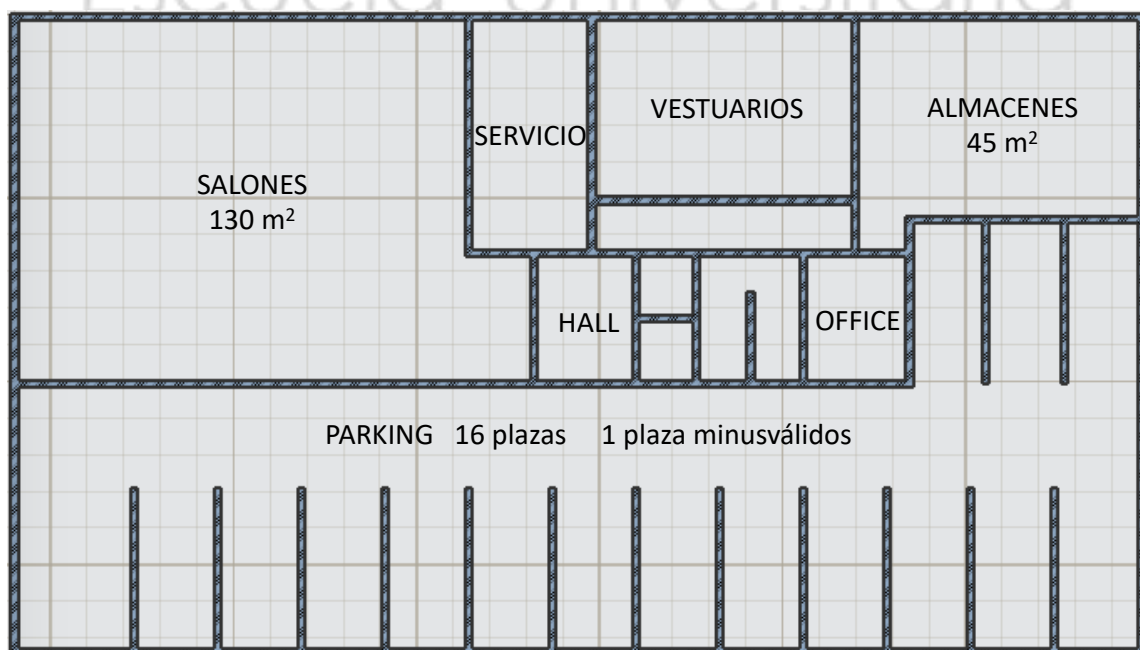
Planos: Planta subterránea. Fuente: Elaboración Propia
